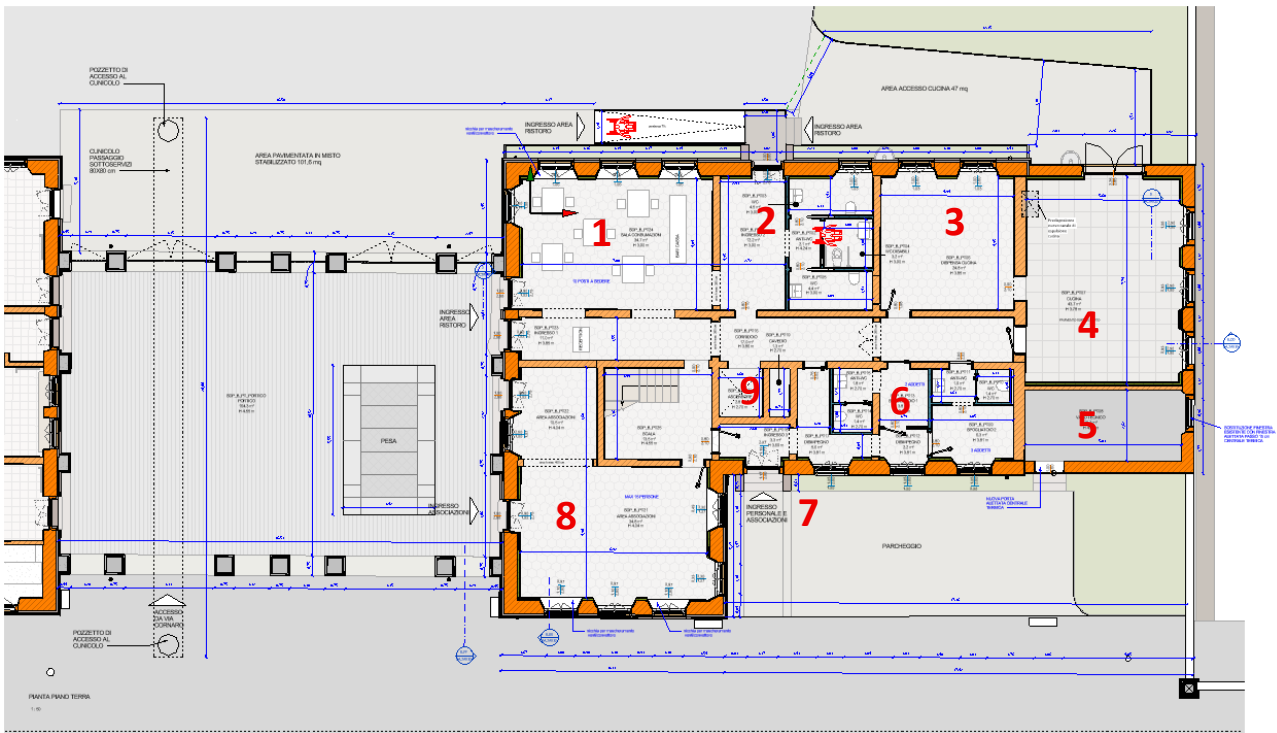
EDIFICIO B - Stato di progetto pianta piano terra.
